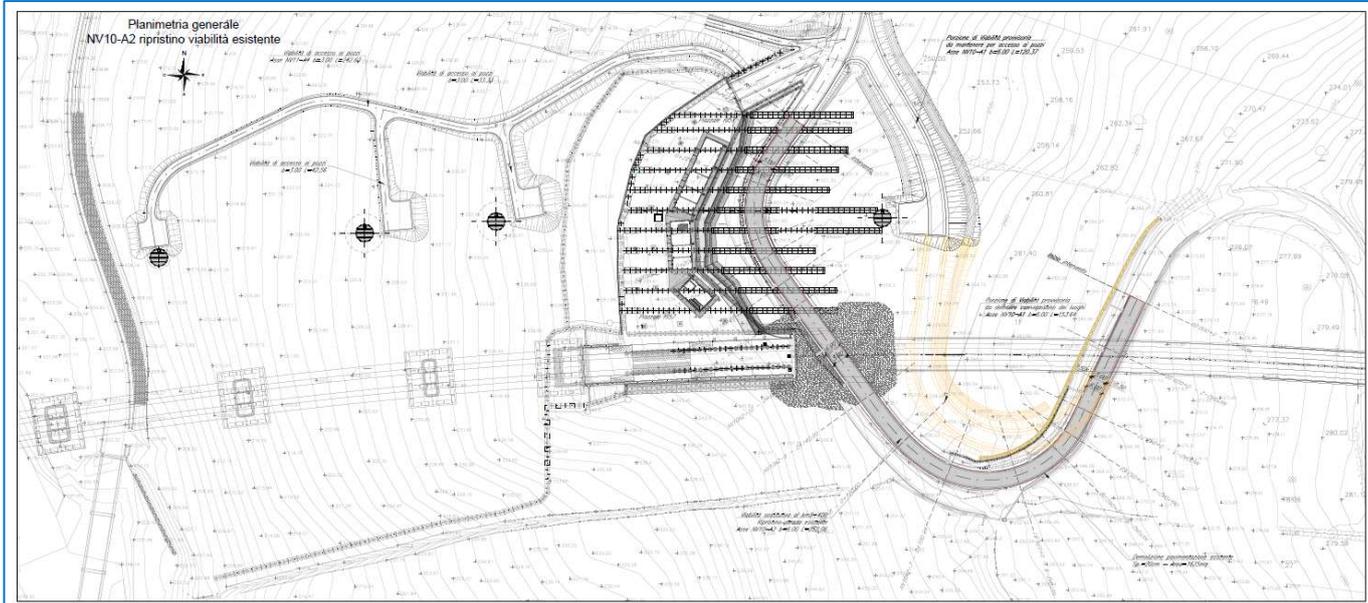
Planimetria Viabilità Definitiva NV10
